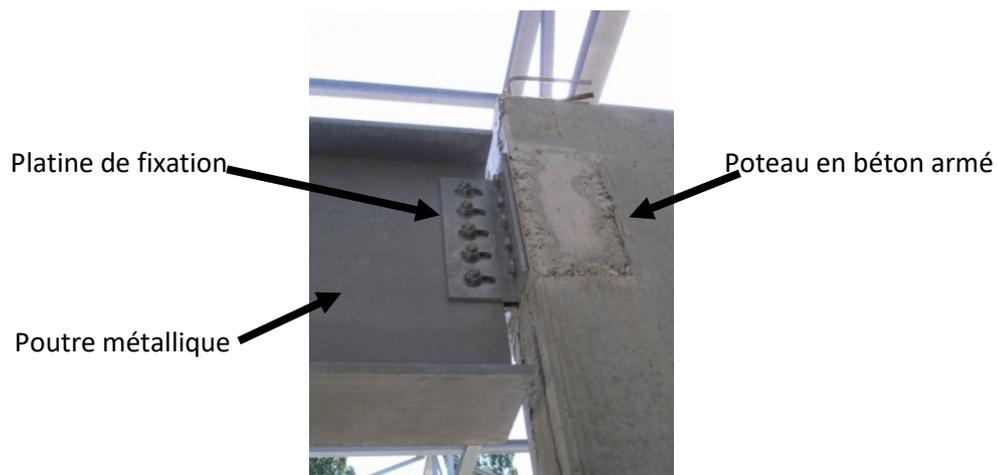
Détails de jonction poutre métallique- poteau en béton armé
